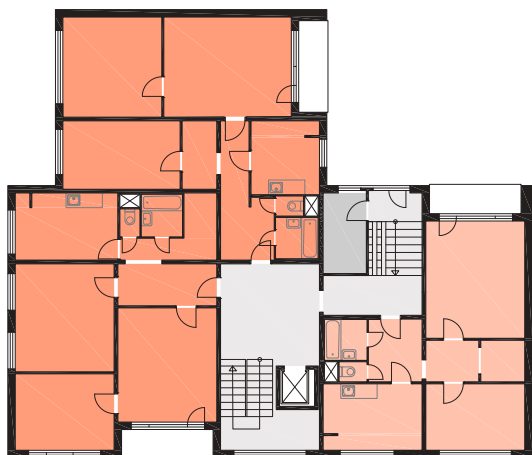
Konstrukční soustava OP 1.11 (Zdroj: panelaky.info)
